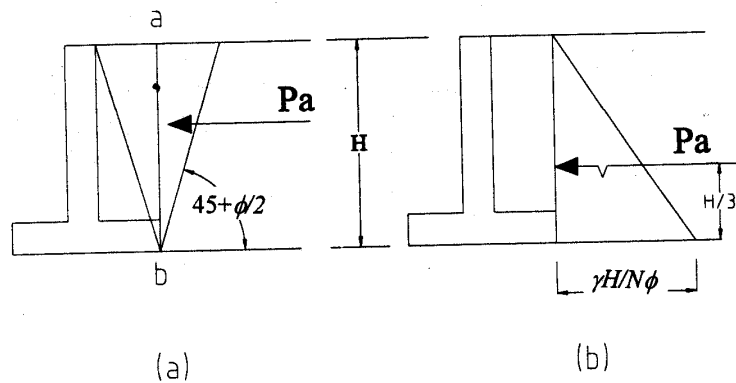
a) Rotura de la arena situada detrás de un muro,
